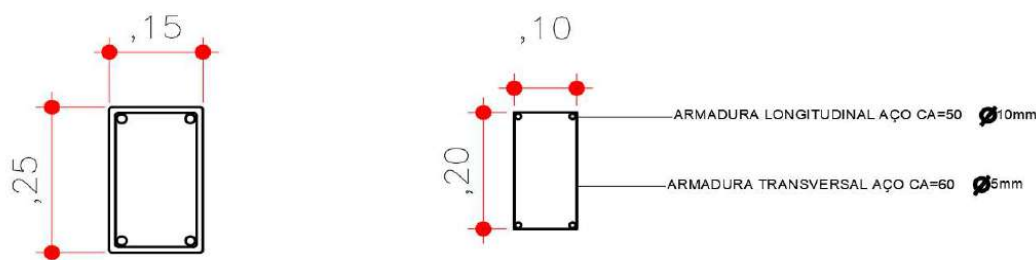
Seção de aço dos pilares e detalhes da armadura long/trans.
